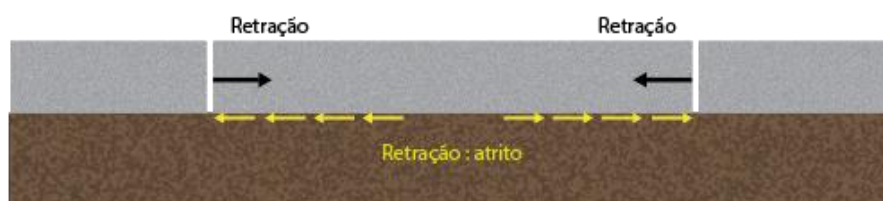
Retração do betão (adaptado de OLIVEIRA, 2000)
